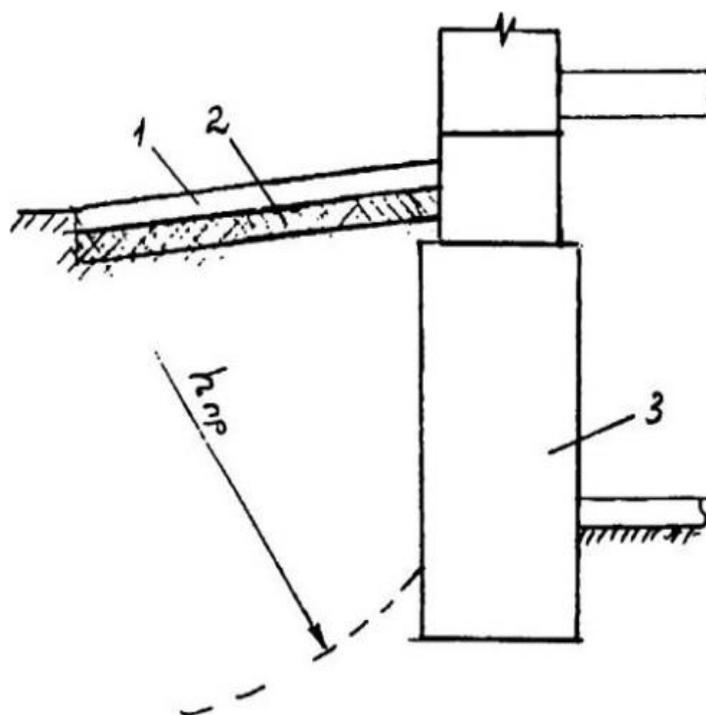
Схема устройства теплозащитного экрана: 1 – отмостка из сборных бетонных плит или монолитного бетона; 2 – теплоизоляционный экран из пенополистирола, обернутого полиэтиленовой пленкой; 3 – фундамент; $h_{пр}$ глубина промерзания.
